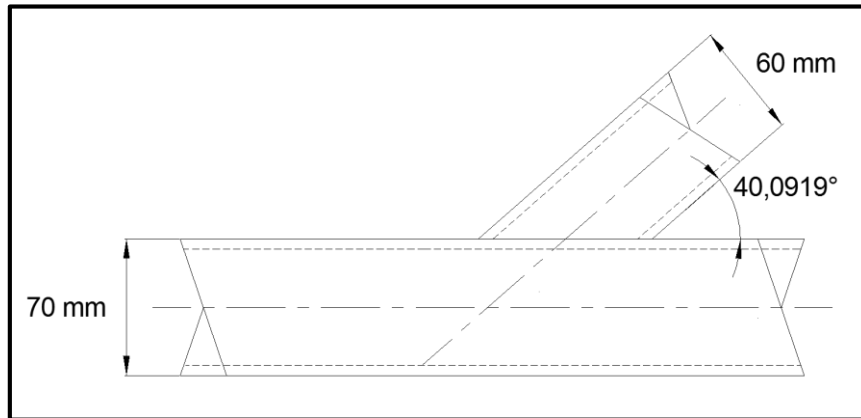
Detalle de las juntas de la armadura, conexión en Y-
